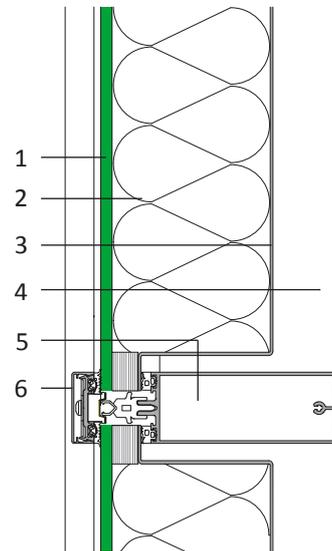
Fassade mit opaken Brüstungspaneelen
